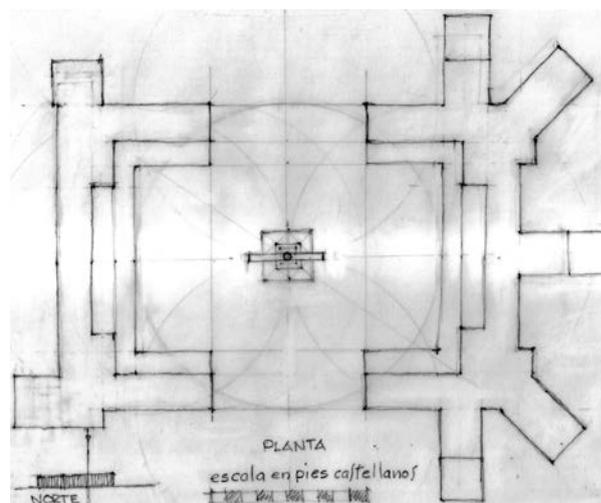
Planta “cámara de los secretos”, escala 10 pies.
